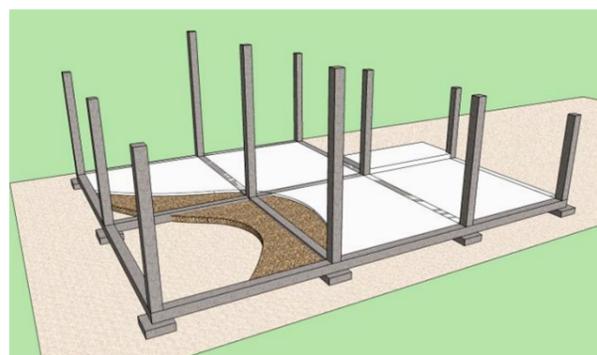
Modelo digital de la estructura de hormigón armado y piso de hormigón simple.
